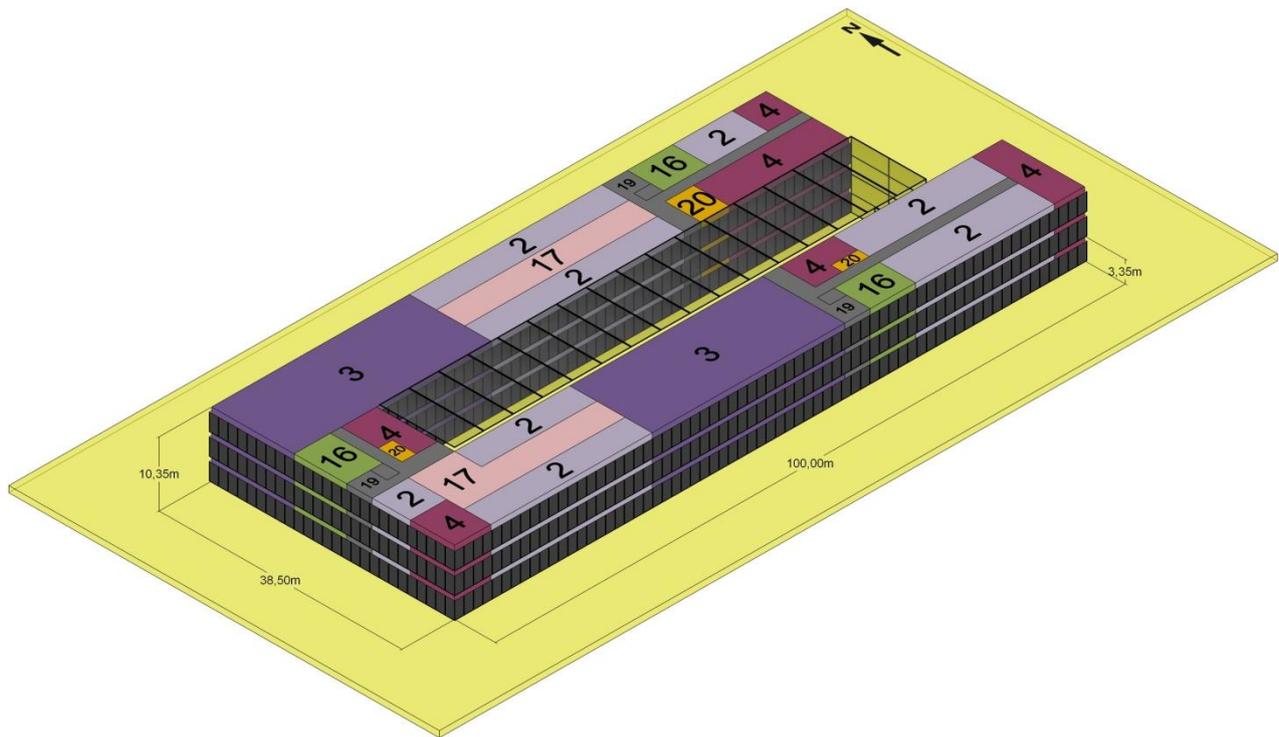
Büros - groß - Darstellung Zonen - Ansicht Süd-West
